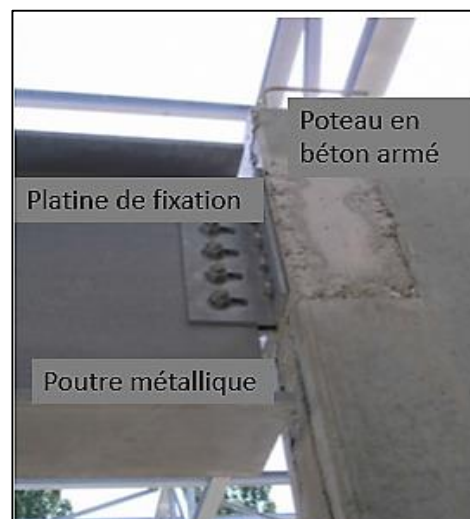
détail de jonction poteau en béton armé et poutre métallique
